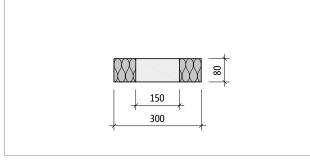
Schöck Sconnex® Typ W-N: Produktgrundriss; Drucklagerfläche 150 mm × 100 mm
